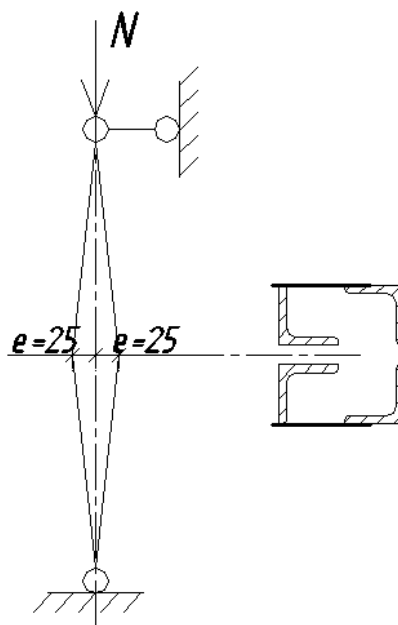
Расчетная схема деформированного стержня, усиленного с применением сварки
